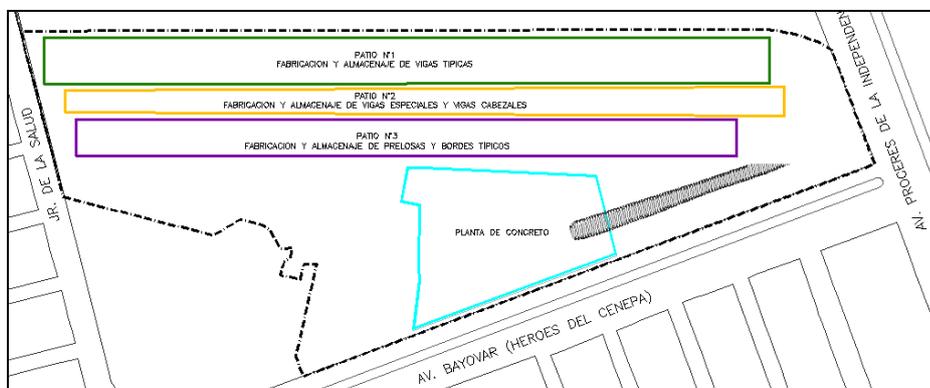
Layout Planta de Prefabricados Tramo 2 –Línea 1.
